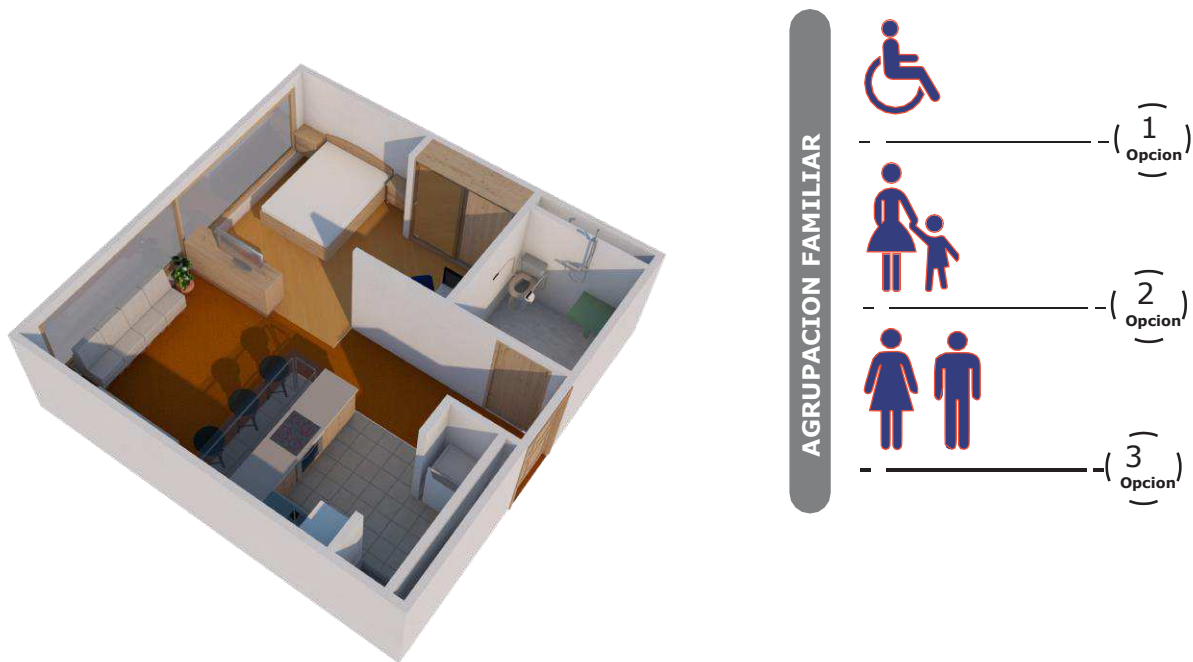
Planta tipo N. 1, Vista 3D, agrupación, Planta técnica. Autor.
